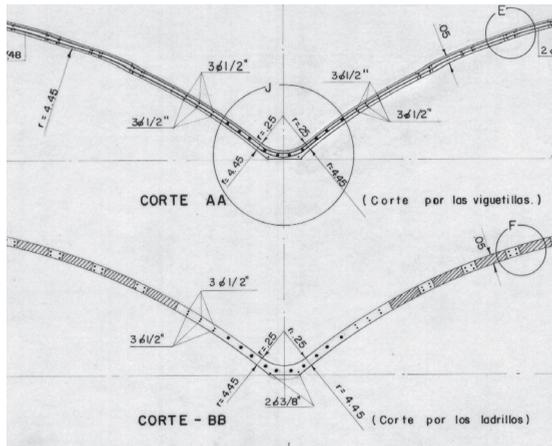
Detalle de las uniones entre las bóvedas de la fachada del edificio Volkswagen (1955).
